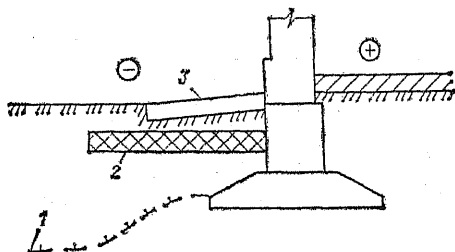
Тепловая изоляция грунта около фундамента для уменьшения глубины промерзания и глубины заложения подошвы фундамента
